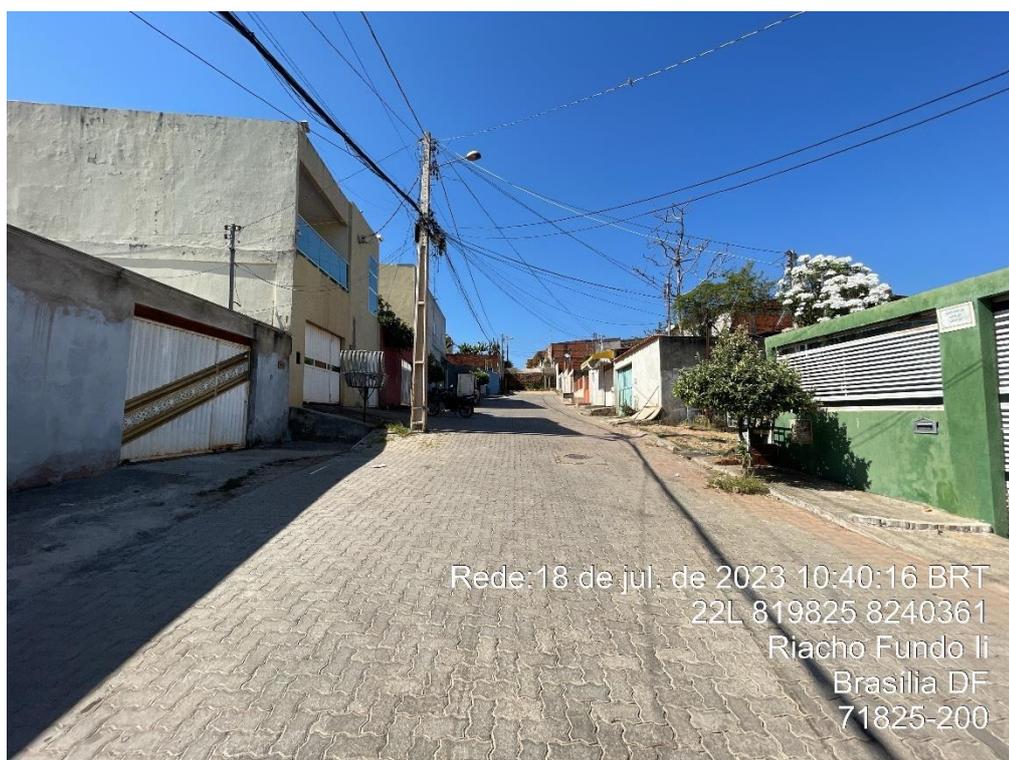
Trecho de via em que foi utilizado pavimento com piso intertravado.
